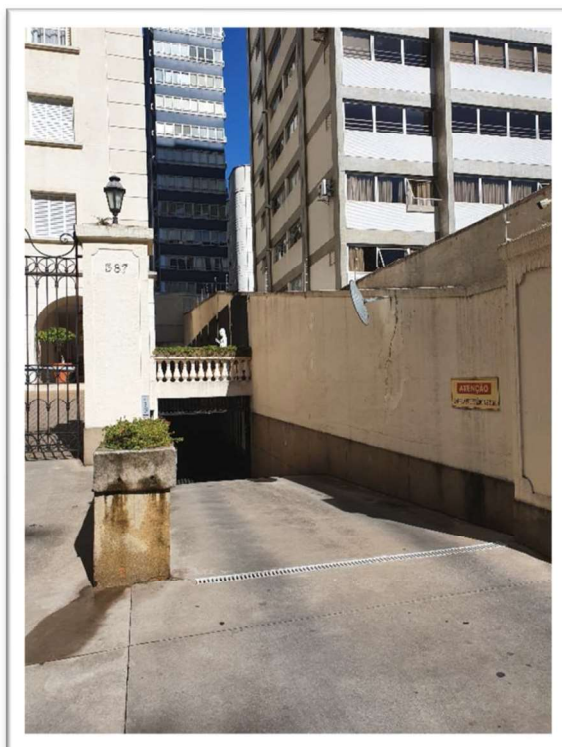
DETALHE DA ENTRADA DA GARAGEM
